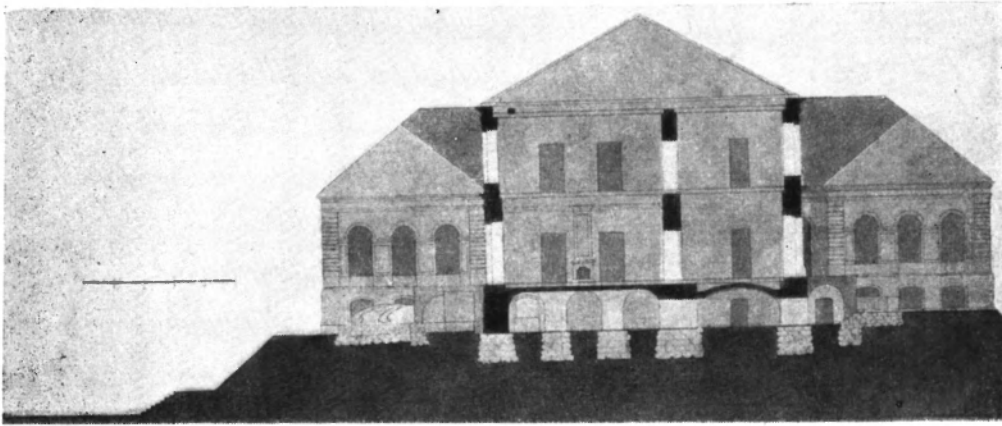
Поперечный разрез главного корпуса усадьбы Бестужева-Рюмина.
